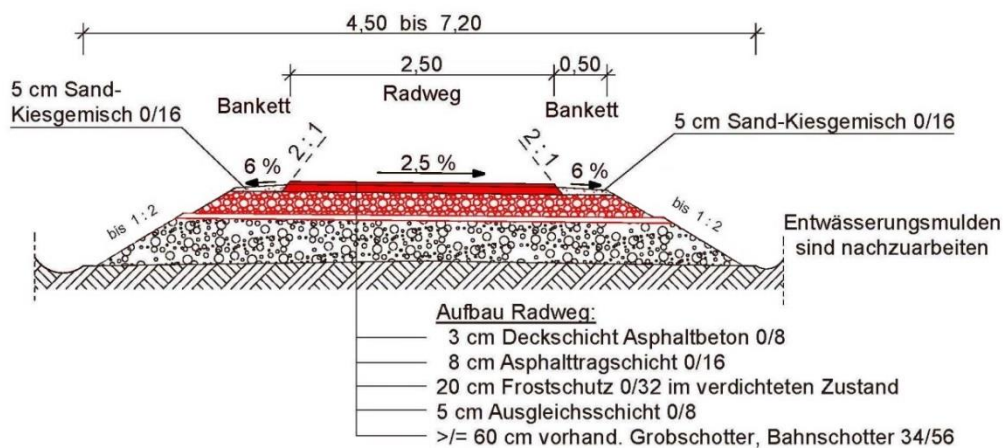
Bestand Bahntrasse und geplantes Regelprofil
